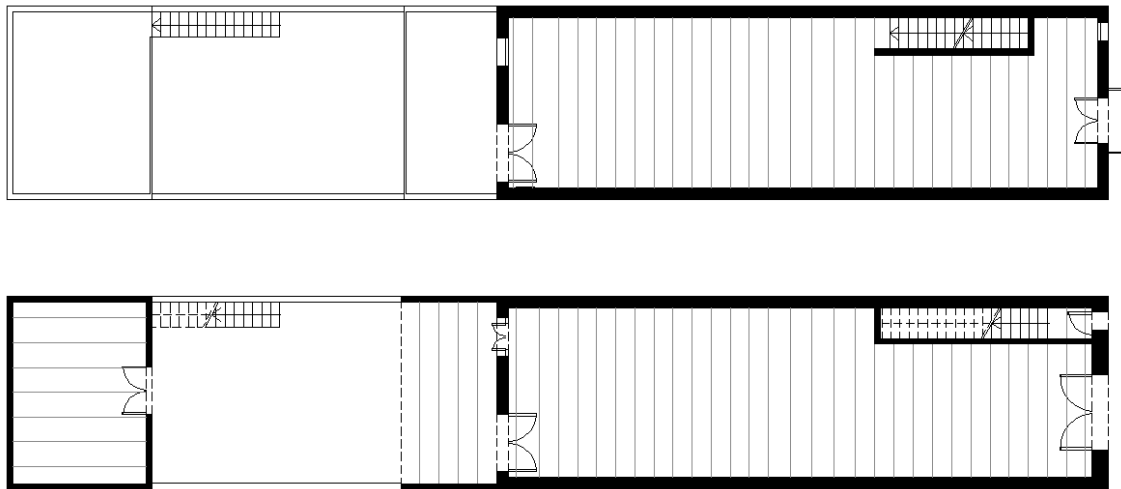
a Plantas tipo casa artesana unifamiliar (planta piso y planta baja)
